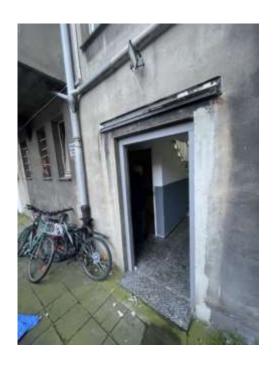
Eingang zum Haus Kaiser-Friedrich-Straße über den Hof
